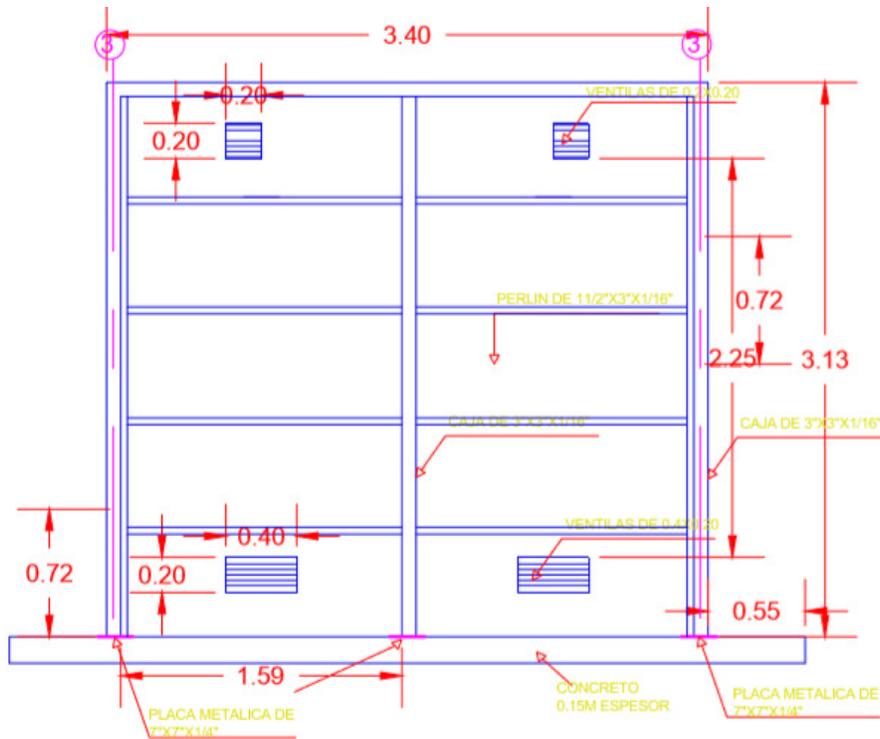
Elevación estructural vista trasera, Fuente: PIMA.
